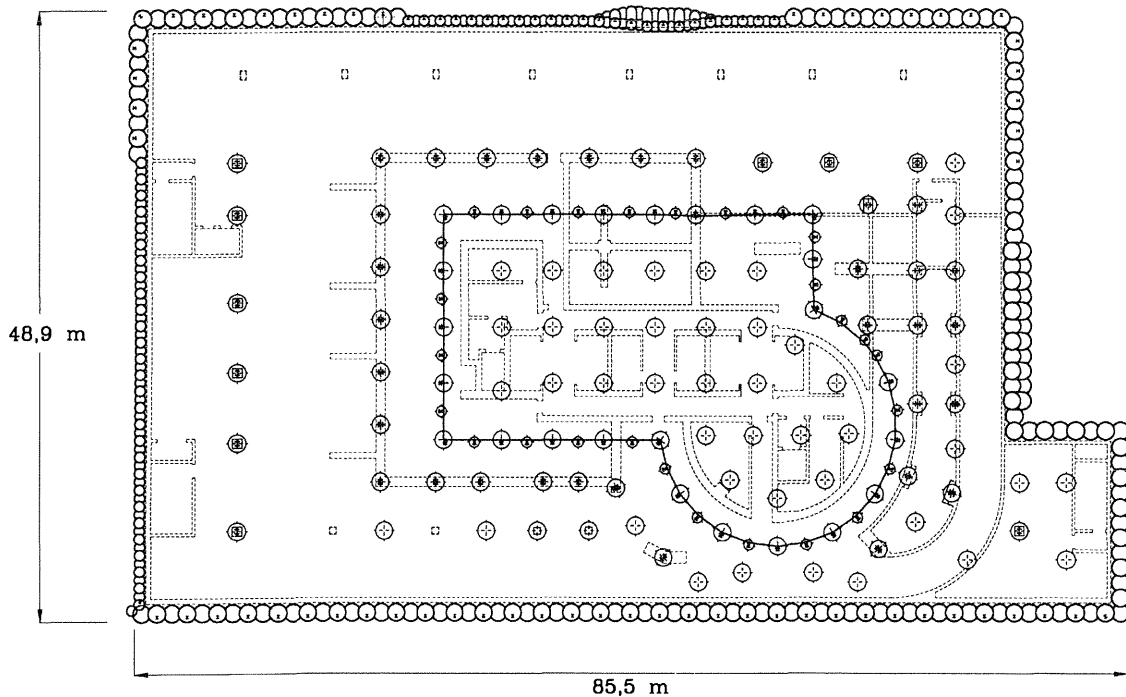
MAIN TOWER - Grundriß mit Darstellung von Verbauwand und Gründungspfählen
